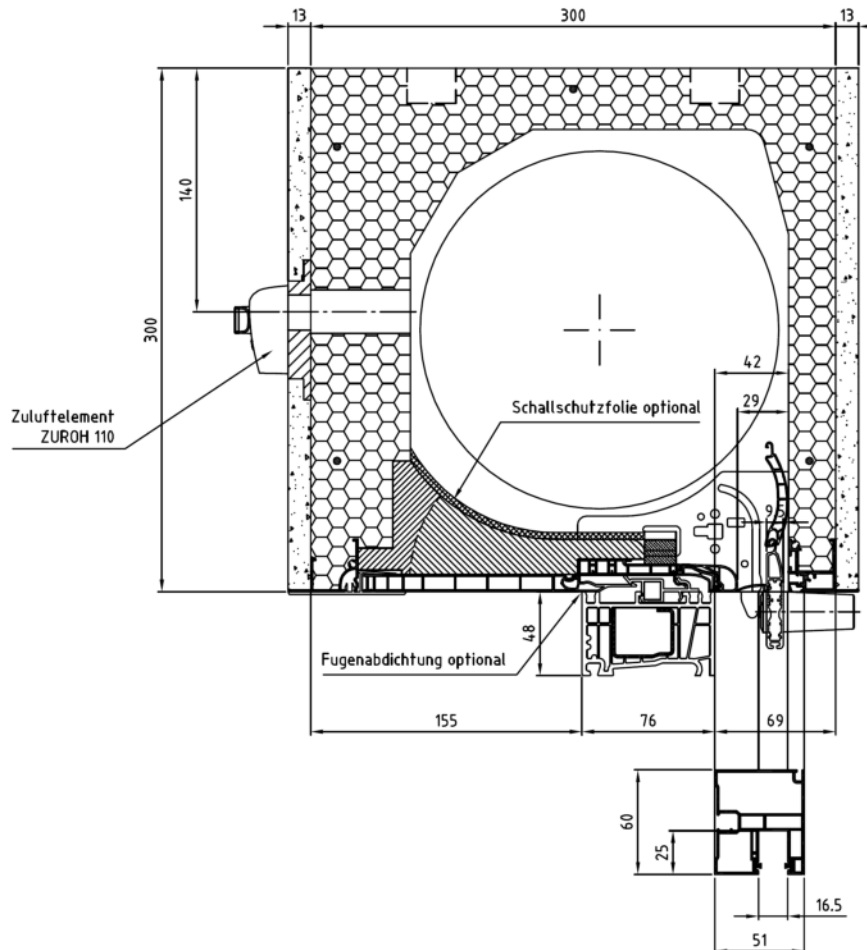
Schnittzeichnung (Grundsatzdetail, Prüfung ohne Fugenabdichtung und Schallschutzfolie)
